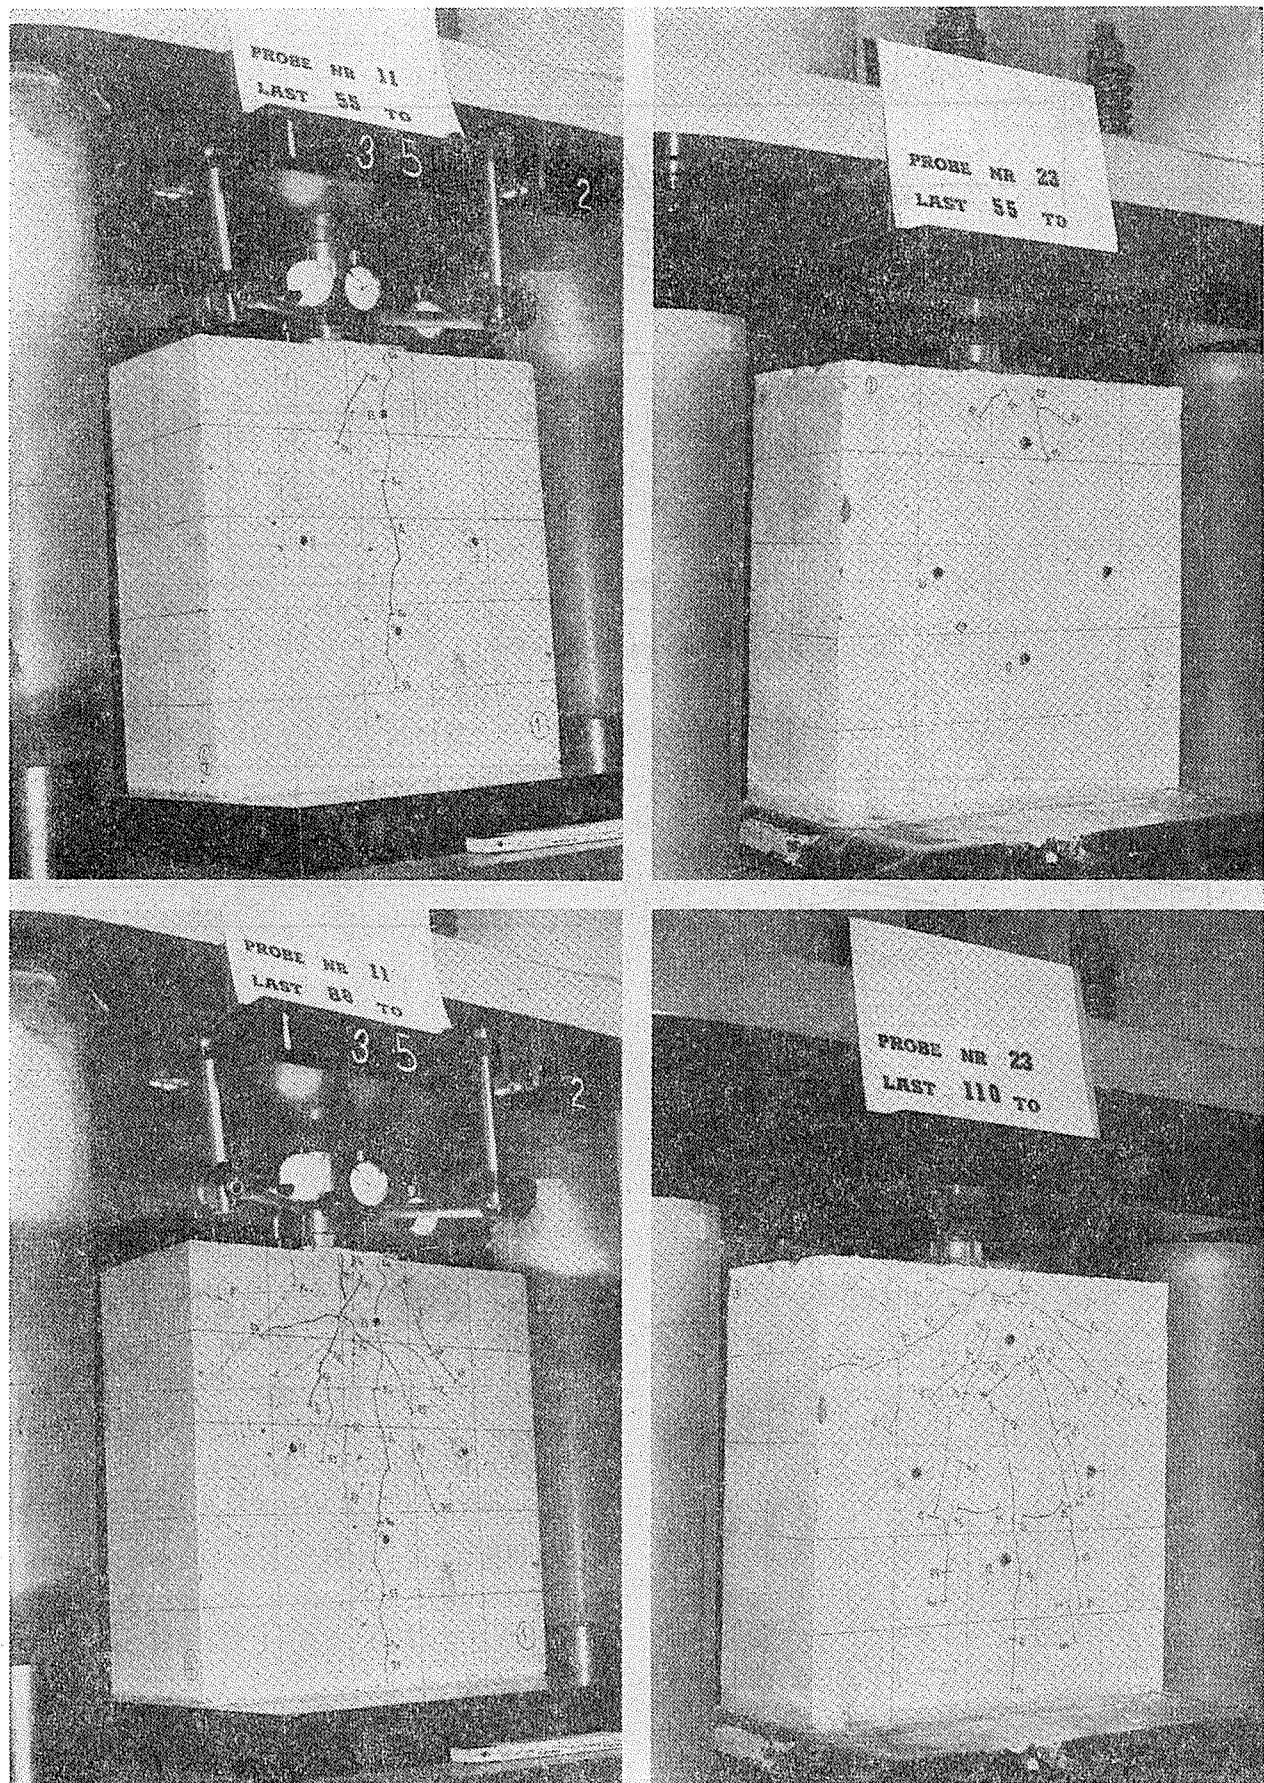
BBRV 工法標準型 (B-360) と急速型 (BR-360) 定着体用供試体のひび割れ状況の比較
